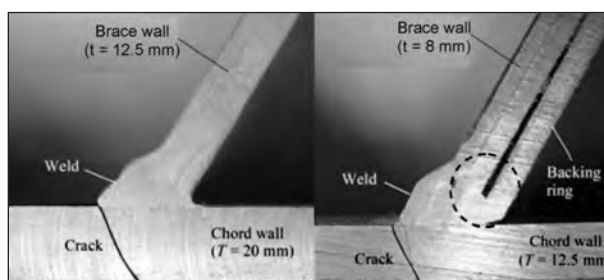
Ohne Schweißbadsicherung (links), mit Backing Ring (rechts) [SCHUMACHER 2003]
